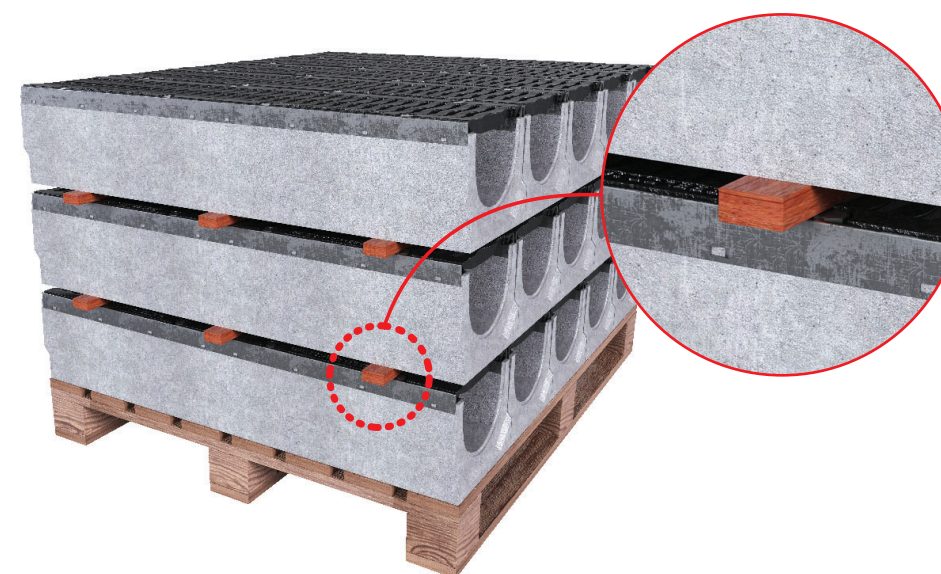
Размещение бетонных водоотводных лотков на поддоны с использованием прокладок для защиты от повреждений
